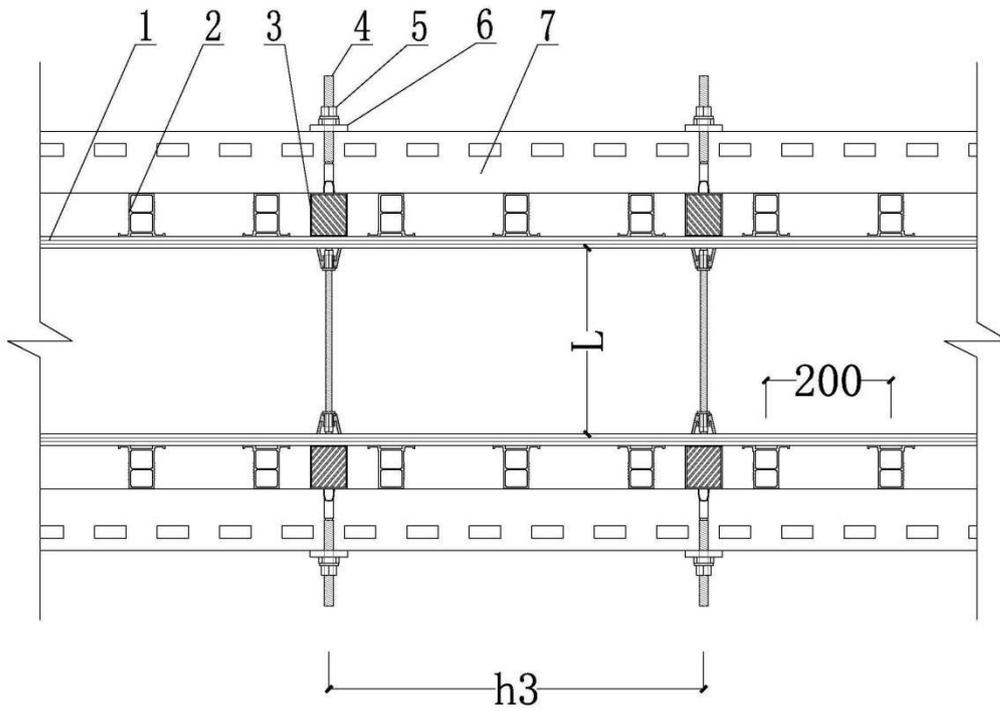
五段式止水对拉螺栓紧固的节点构造平面示意图
